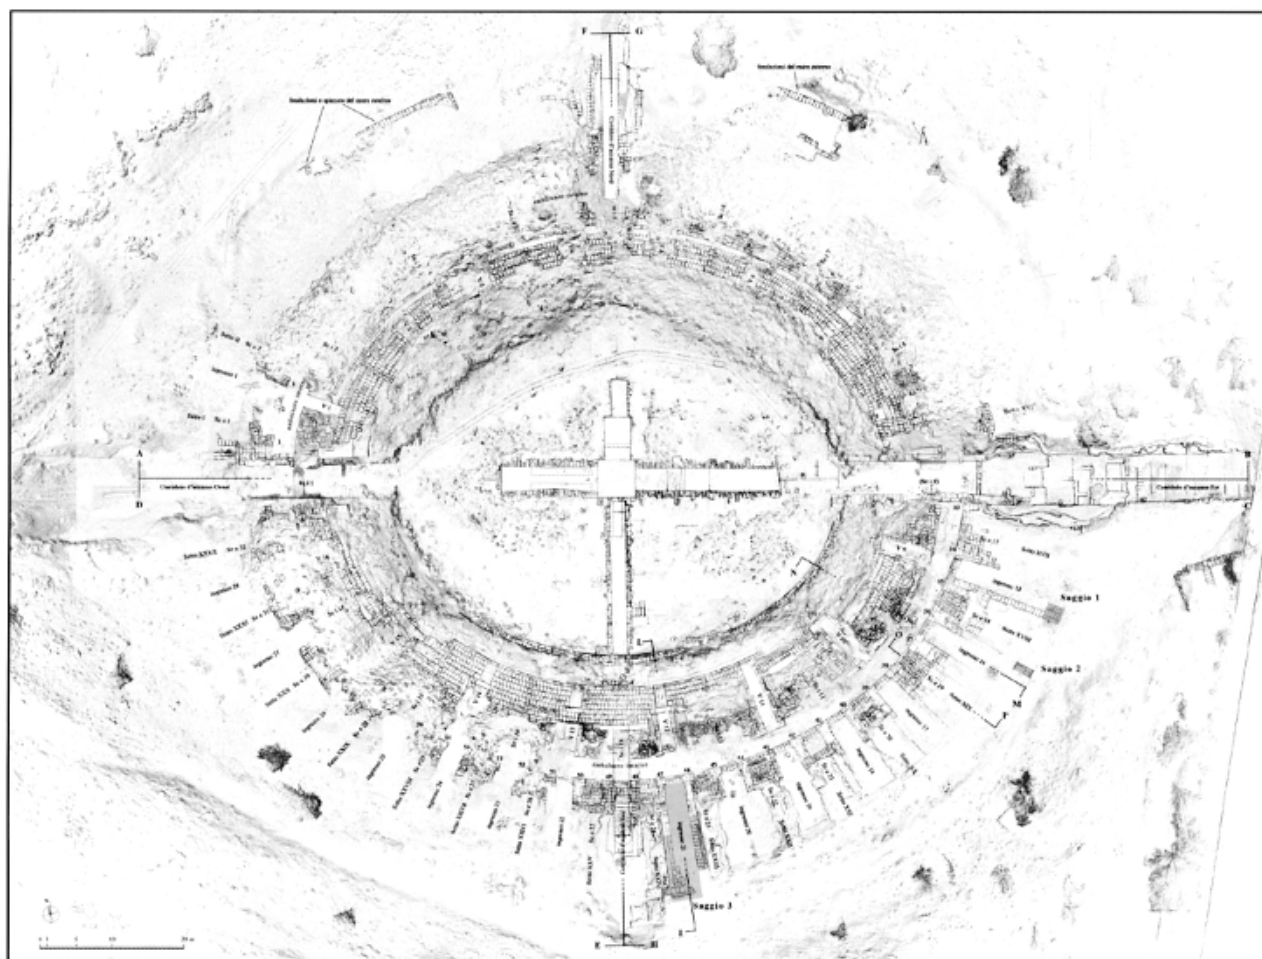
Sabratha, anfiteatro. Planimetria generale del monumento.
